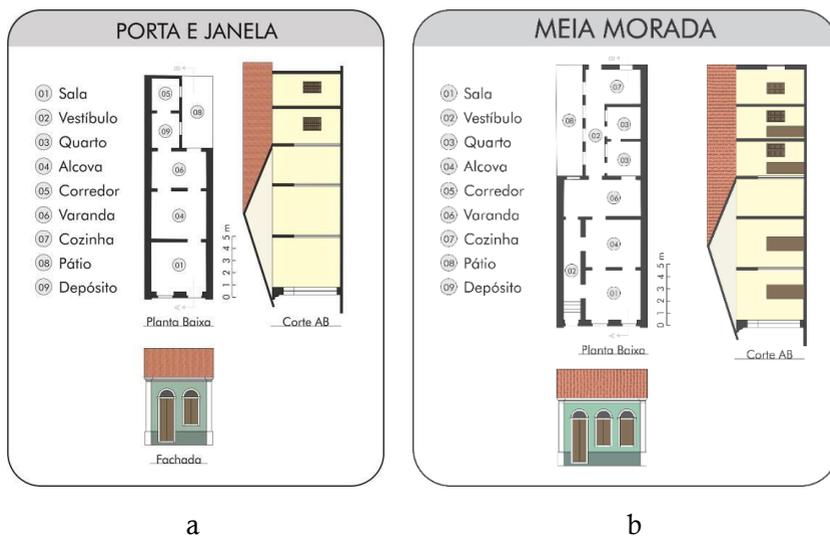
a: Desenho esquemático de fachadas, corte e planta baixa de uma porta-e-janela. Fonte: Adaptado de Silva Filho, (1998). b: Desenho esquemático de fachadas, corte e planta baixa de uma meia morada. Fonte: Adaptado de Silva Filho, (1998).
